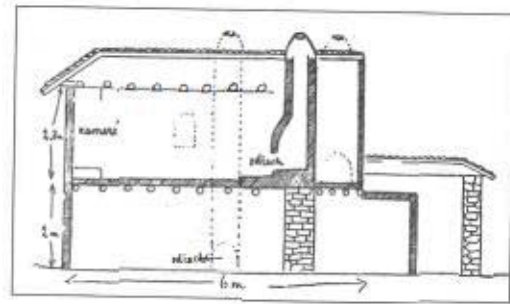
План будинку Асма-кую, 41. Поздовжній розріз [11] / Fig. 4. House plan Asma-kuei, 41. Longitudinal section [11]
